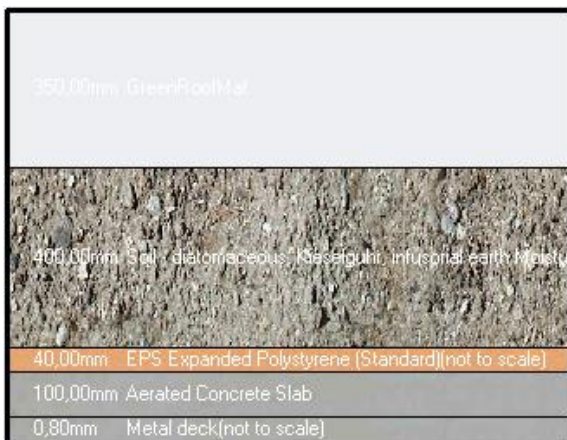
Capas, cubierta con techo verde. Fuente. Elaboración Propia.
